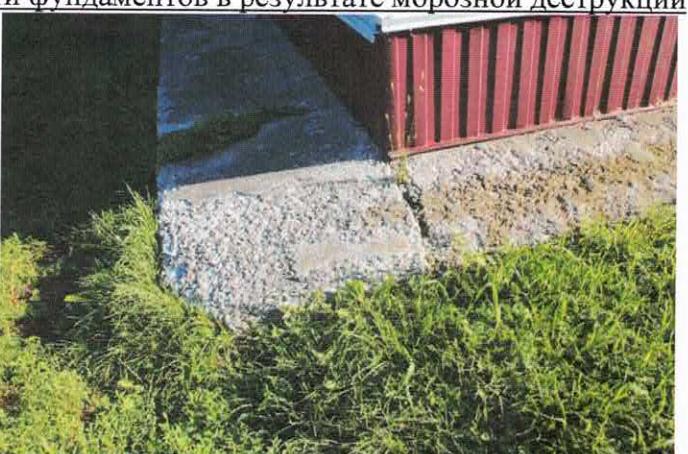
,8.1.8 Разрушение бетона отмостки, наличие трещин в теле бетона
